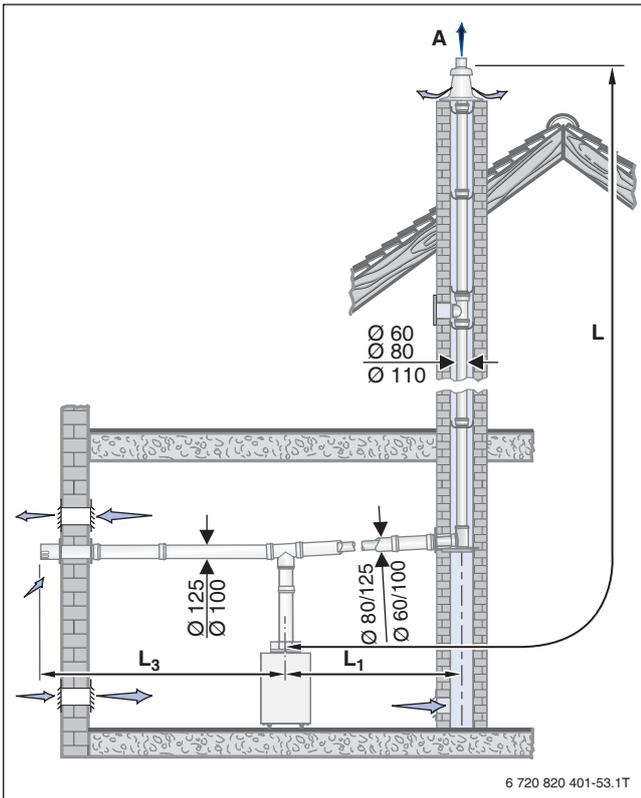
Montagevarianten mit dem Bausatz GA-K + GAL-K
